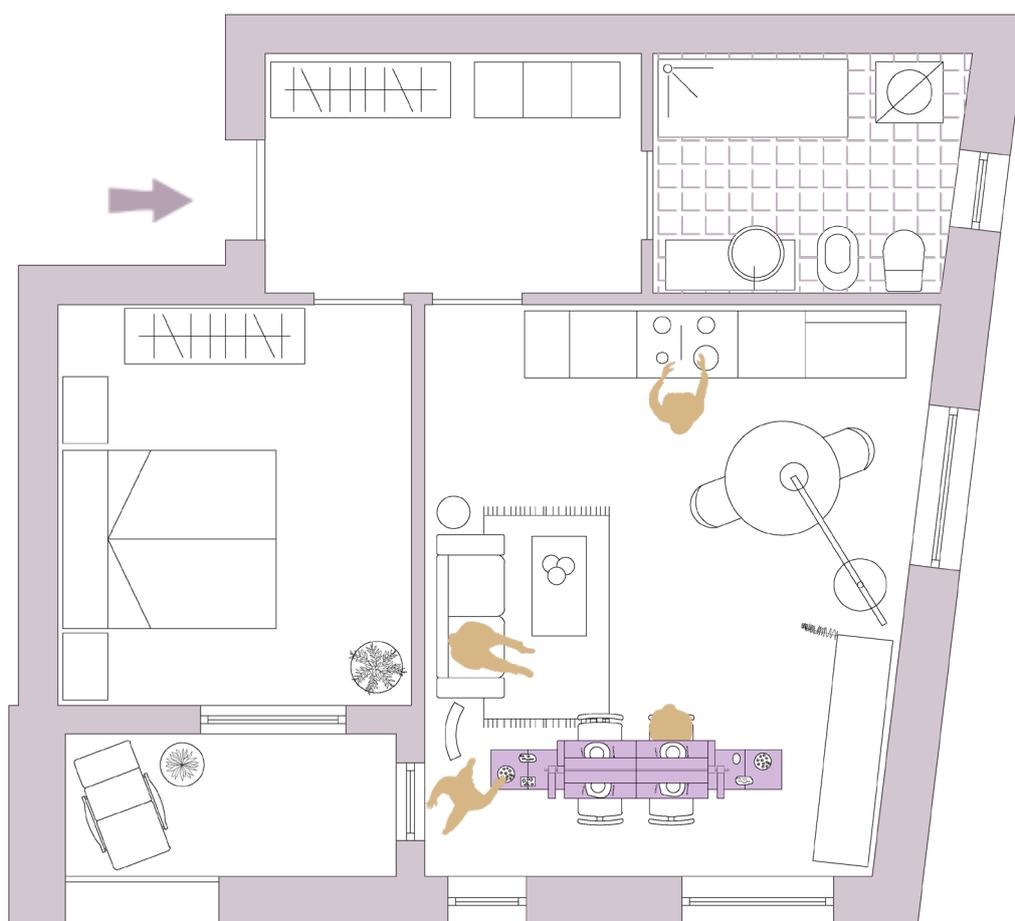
Rappresentazione planimetrica soluzione ambiente conviviale.
